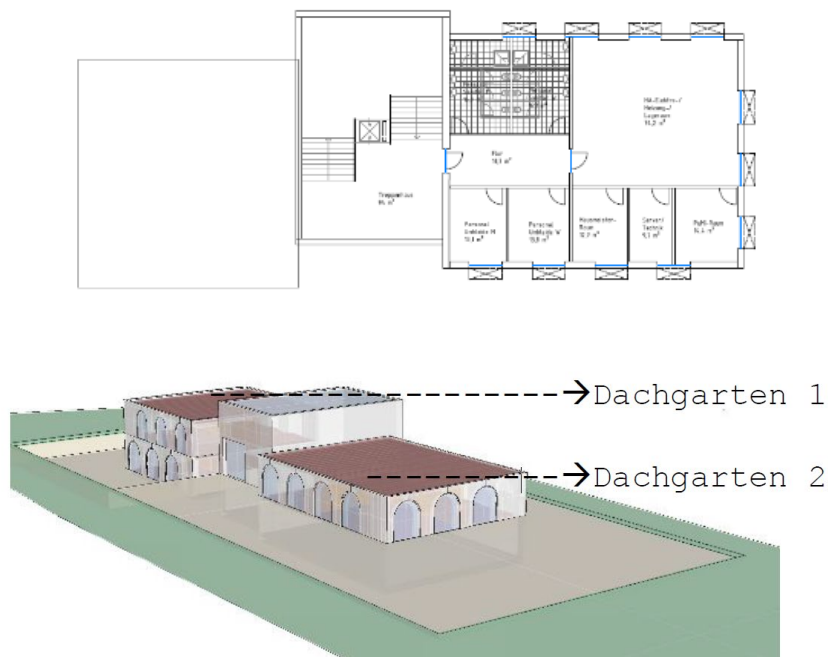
Grundriss 1. Obergeschoss Kita mit Klimahülle, Variante 4.2
